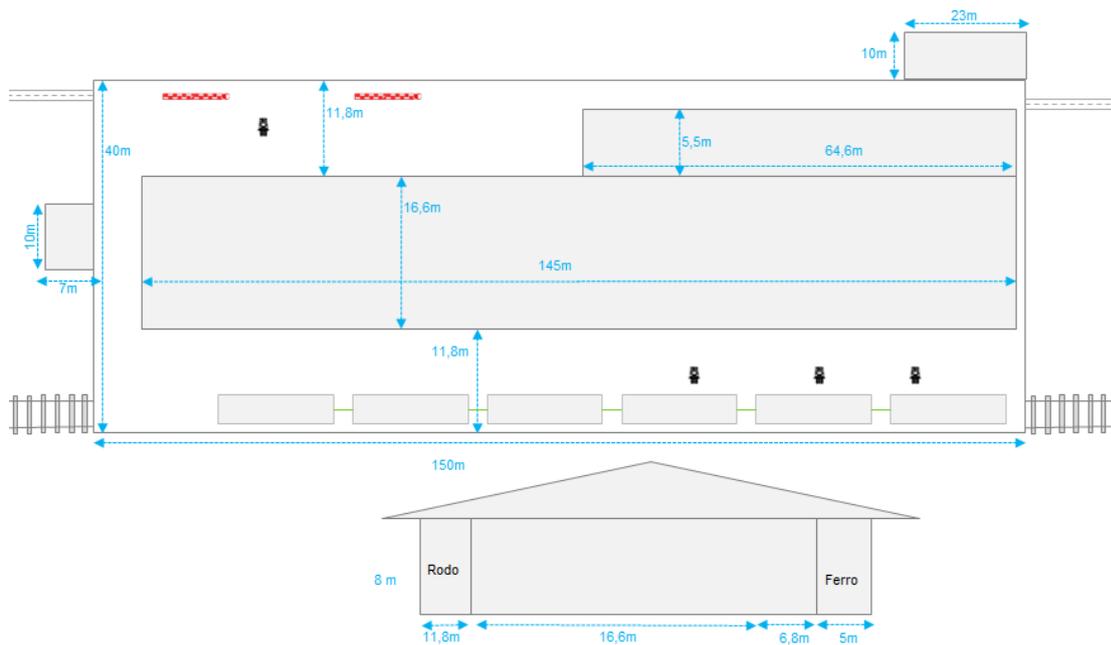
LAYOUT DO ARMAZÉM COM EMPILHADEIRAS
